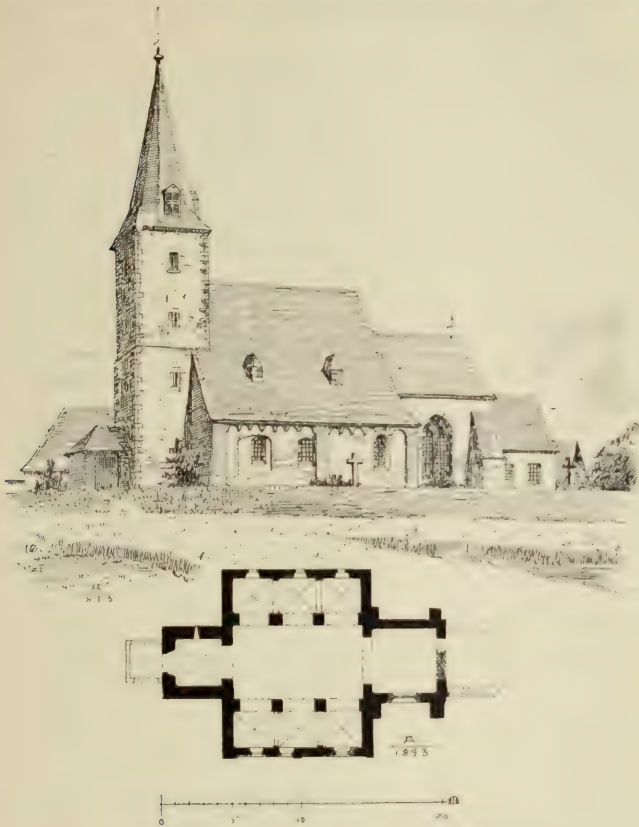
Lövenich. Grundriss und Ansicht der katholischen Pfarrkirche
